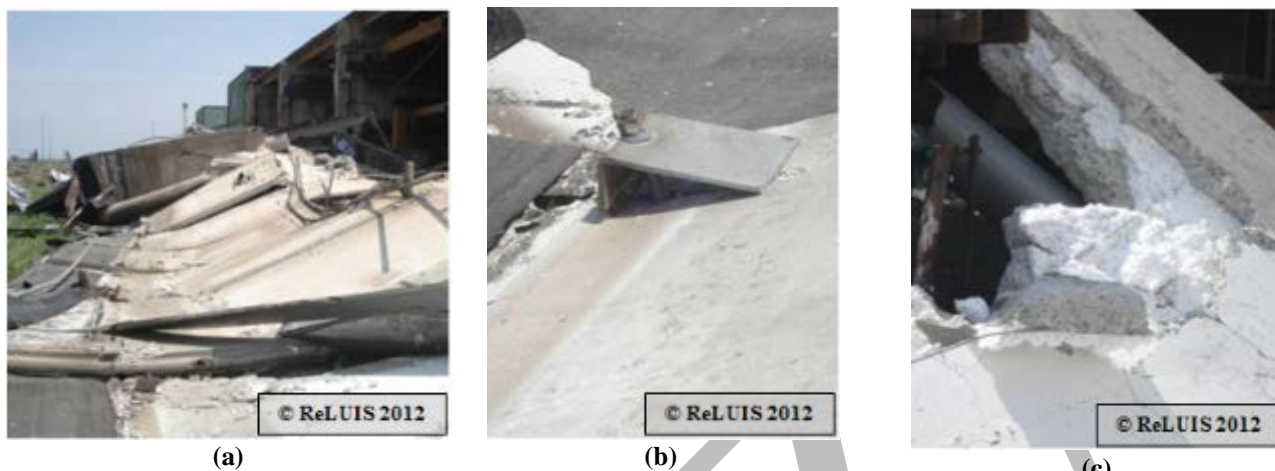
(a) Crollo dei pannelli verticali di tamponamento: (b) dettagli profili della quadretta e del bullone ancora inserito nel profilo a C del pannello crollato e (c) dettaglio sezione trasversale del pannello verticale, costituito da calcestruzzo armato e materiale di alleggerimento e isolante
